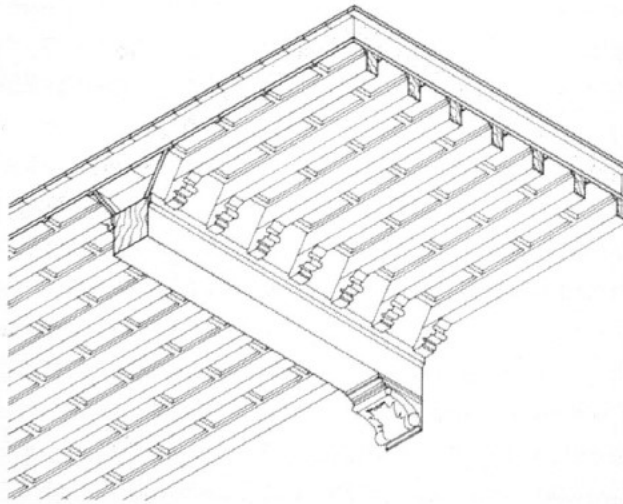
Alex Barry, *Schéma d'un plafond à poutres*, 1991.
